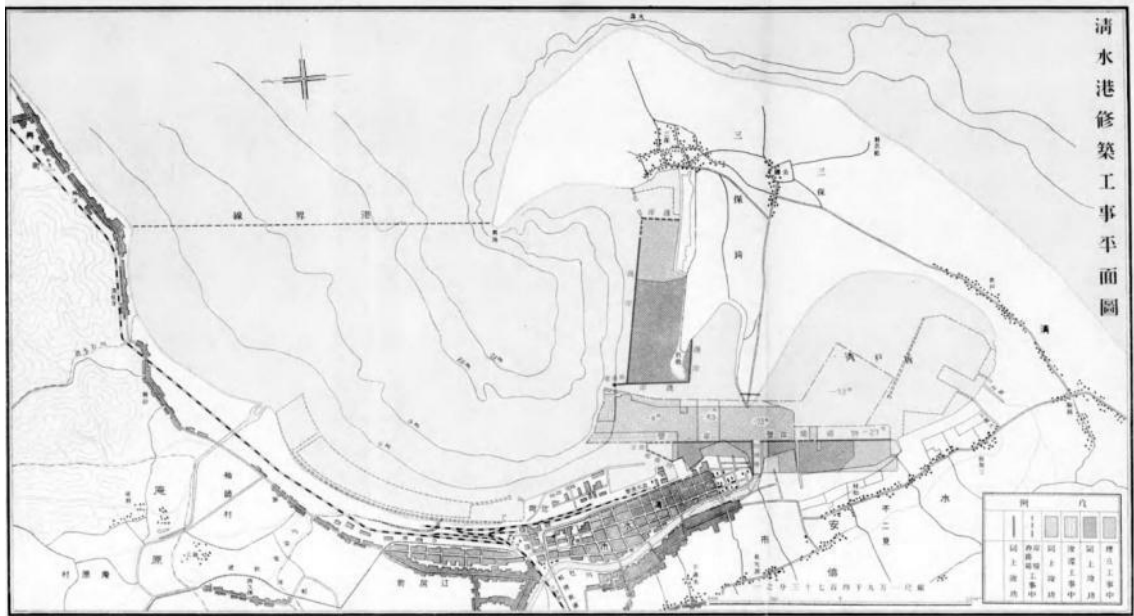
1929 年（昭和 4 年）時点の清水港修築工事平面図 [251]
